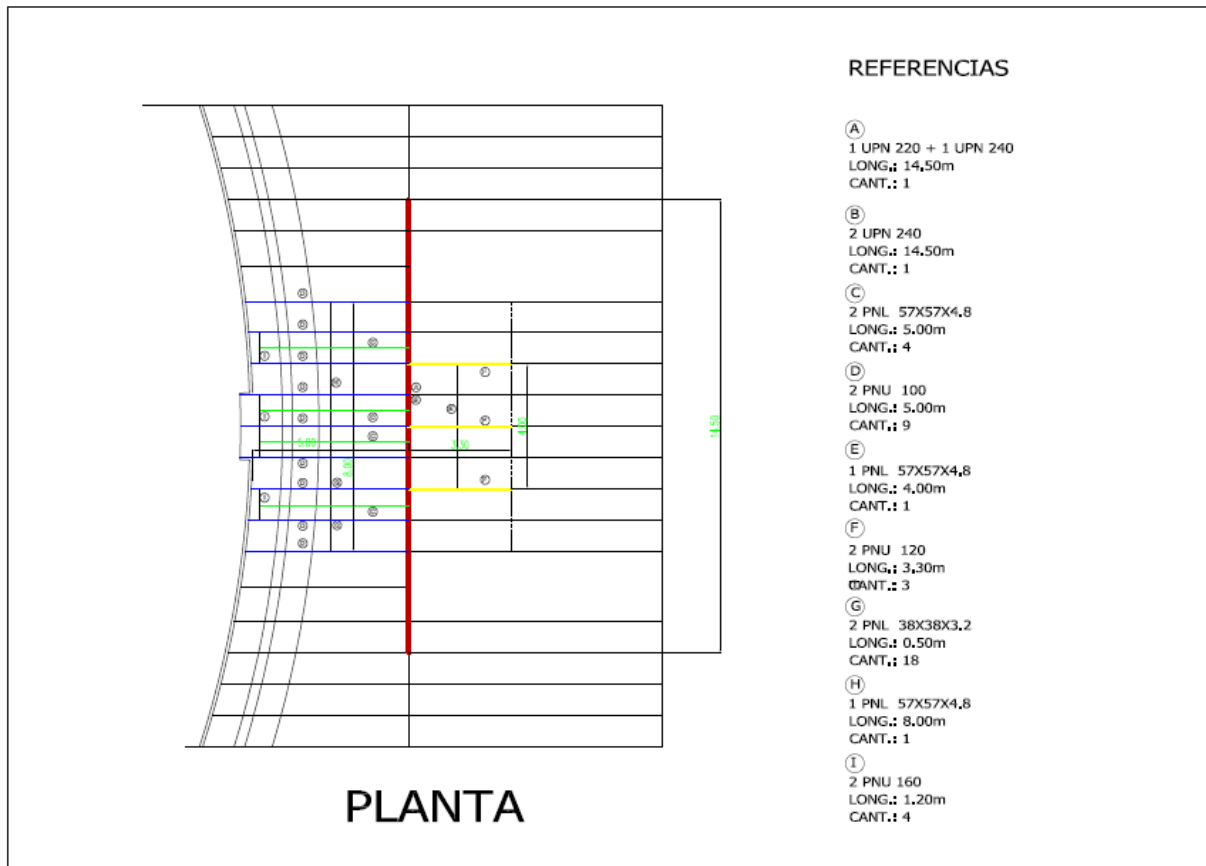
Planta de estructura con ubicación de los refuerzos proyectados (Ver Ref. en Fig. 9)
